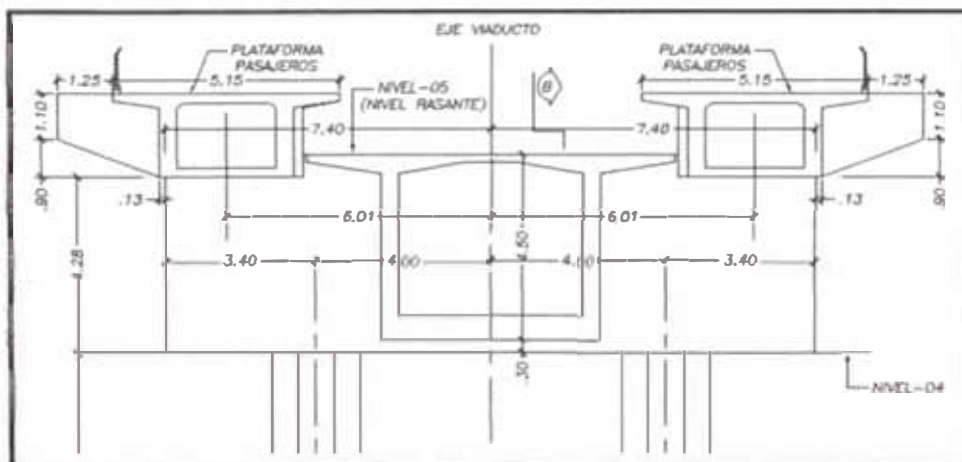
Sección transversal típica de la Viga Cabezal en los pilares S50 y 51
